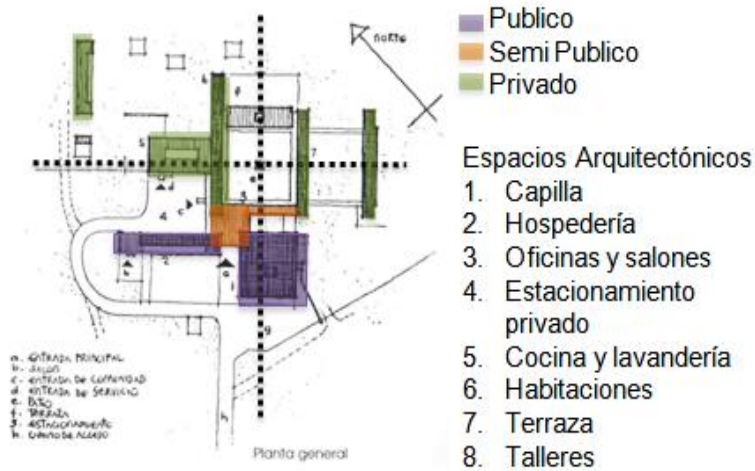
Planta de conjunto. La imagen muestra la ubicación de los ejes compositivos; el eje transversal conecta con la capilla por el centro, en donde se encuentra ubicada una cruz.
